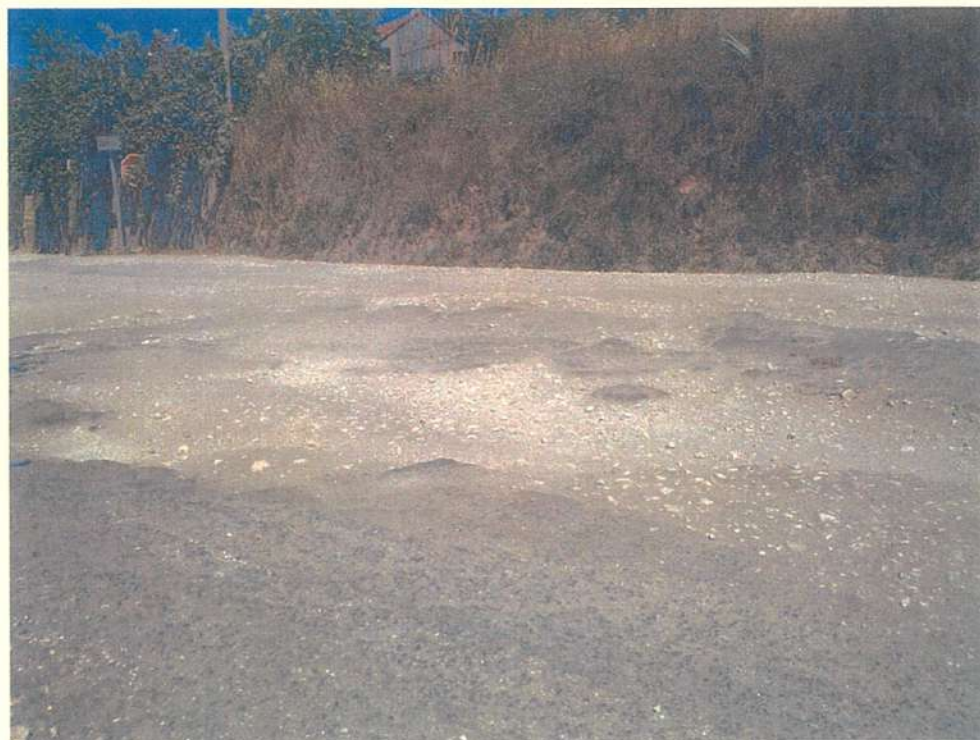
Rua São Miguel – Lugar de Igreja Velha – Mau estado de conservação do pavimento.
